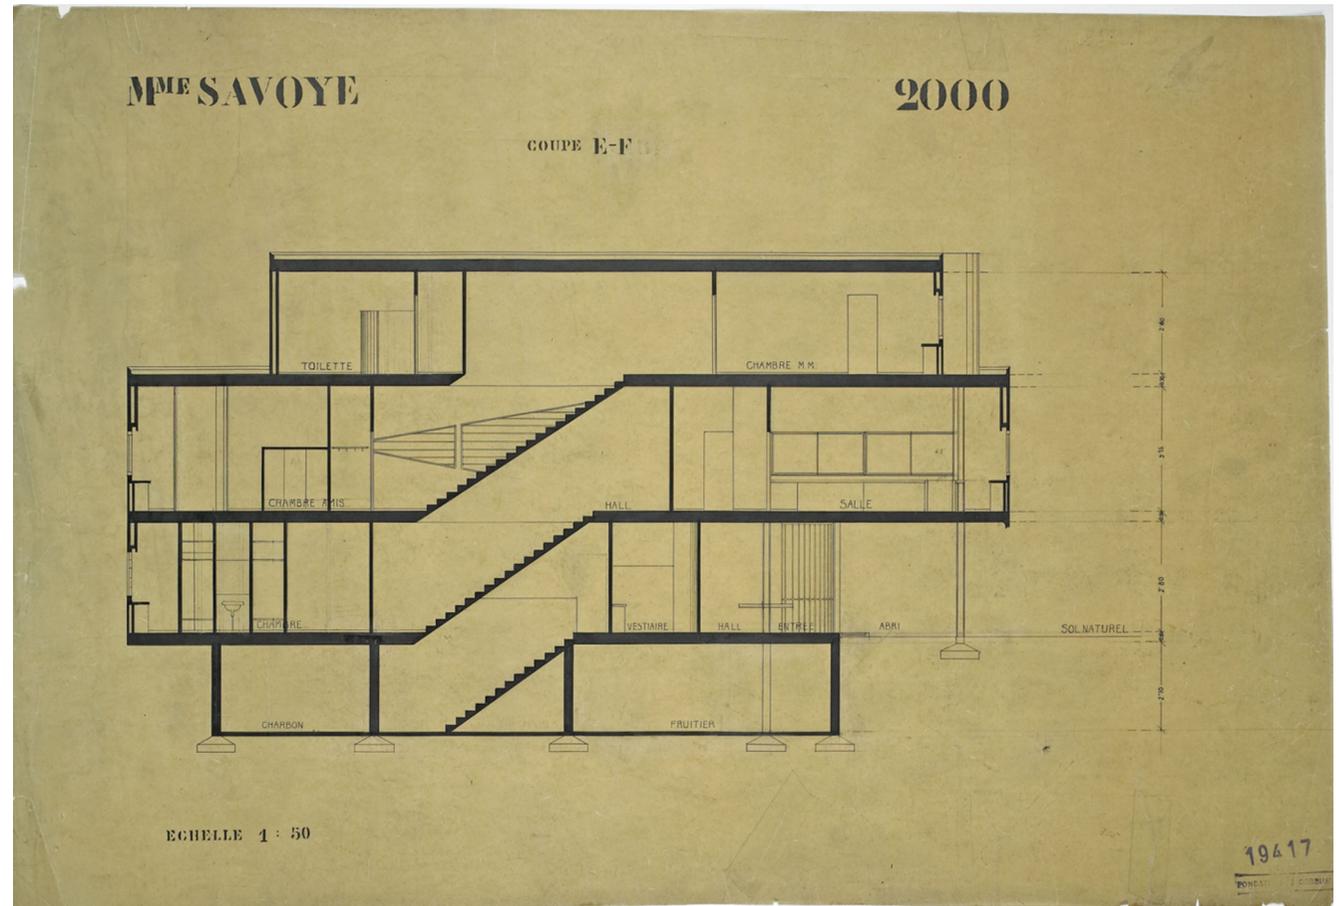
planos de ©FLC/ADAGP. Ville Savoye (19417)
